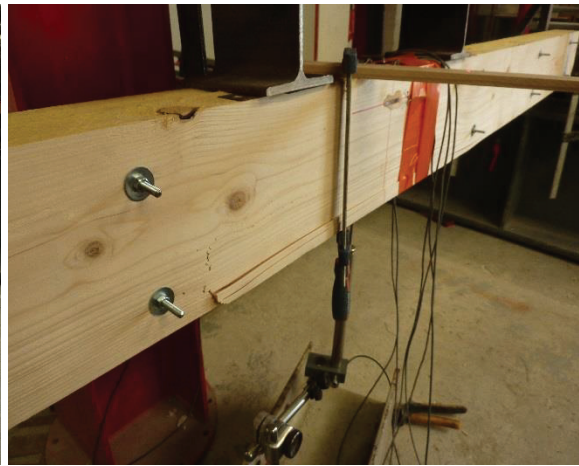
poutre bois Wo5 testée jusqu'à rupture, ruine par traction / cisaillement
